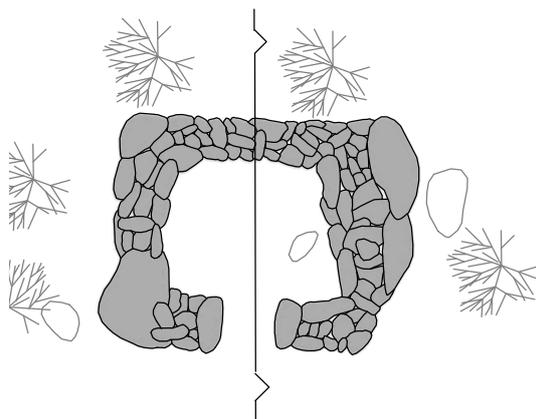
Planta del casal "B" de Ruta el Sardón en Bermillo de Sayago. Fuente: Elaboración propia.
